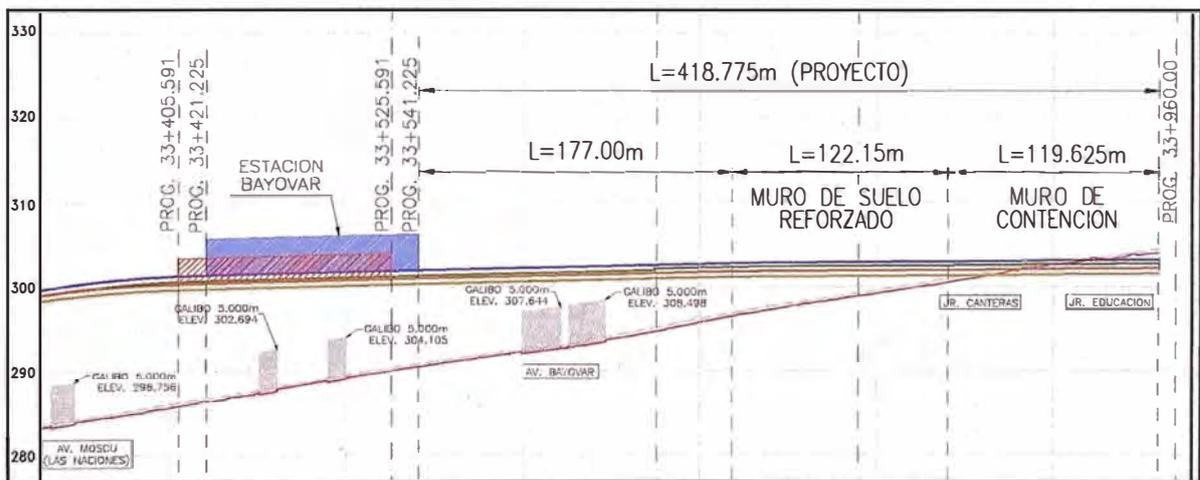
Cola de Vía – Perfil de muro de suelo reforzado y muro de contención de concreto armado.
